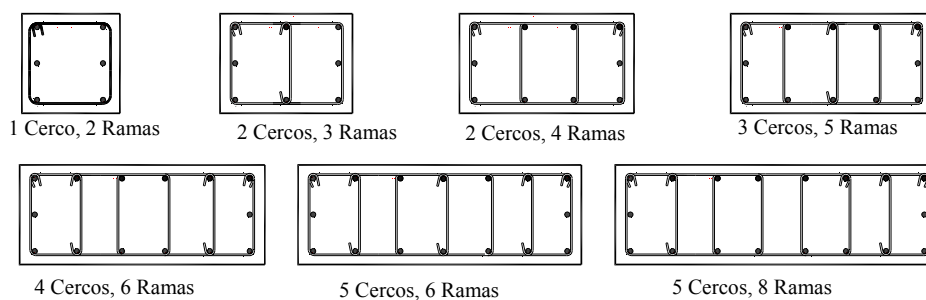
Modelo 5. Patrón de armado. Refuerzo Cortante.
